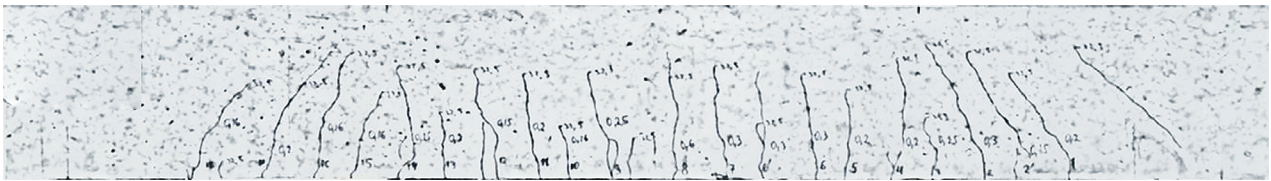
Испытание железобетонной балки ($\mu = 0,015$) на стадии трещинообразования
